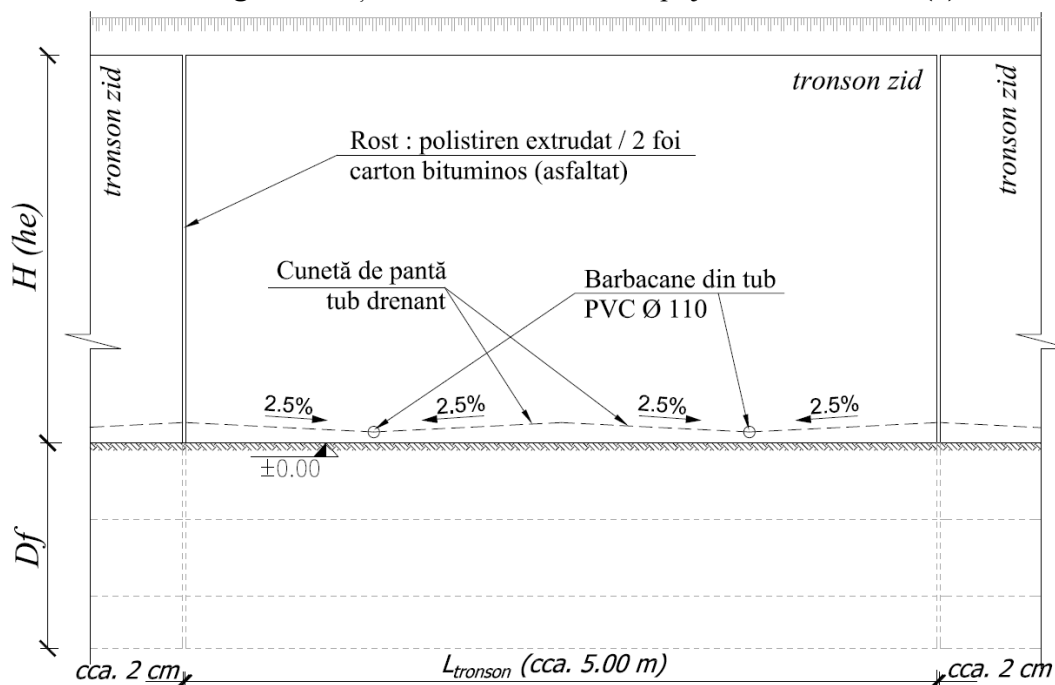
Vedere longitudinală zid de sprijin din beton armat cu barbacane
